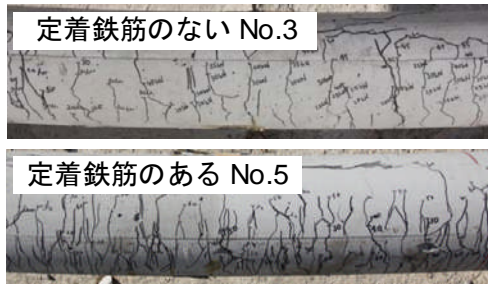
試験後のモーメント一定区間に生じたひび割れ状況
